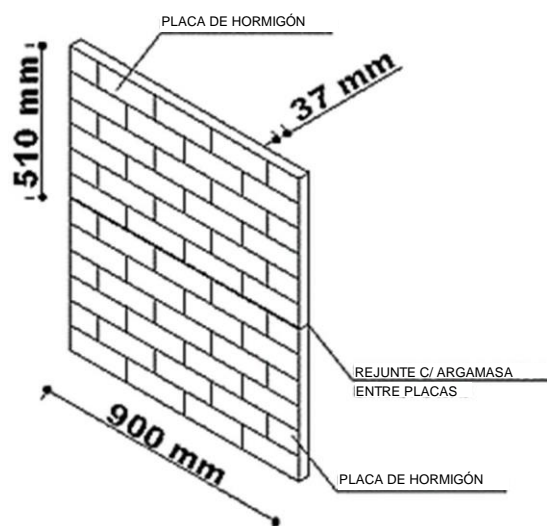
Placa de cerramiento sin función estructural prefabricada en hormigón.
